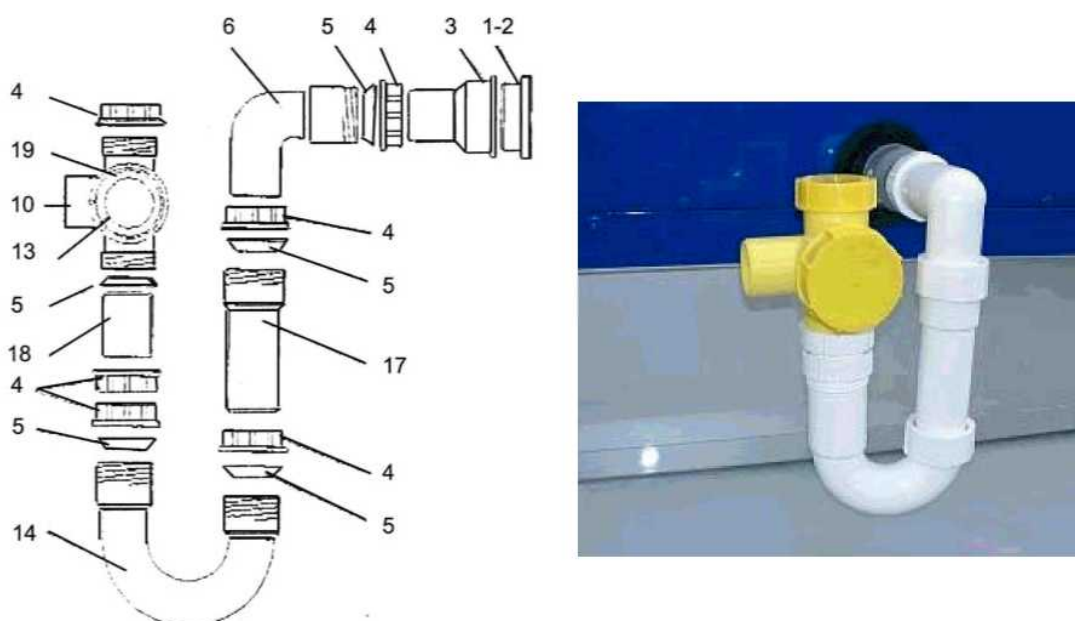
Сифоны типа 100400, 100500, 100600
